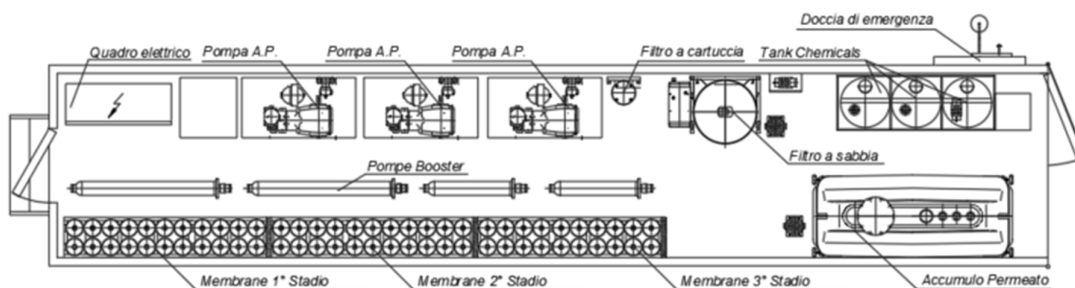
Layout indicativo di un impianto a osmosi inversa a tre stadi
